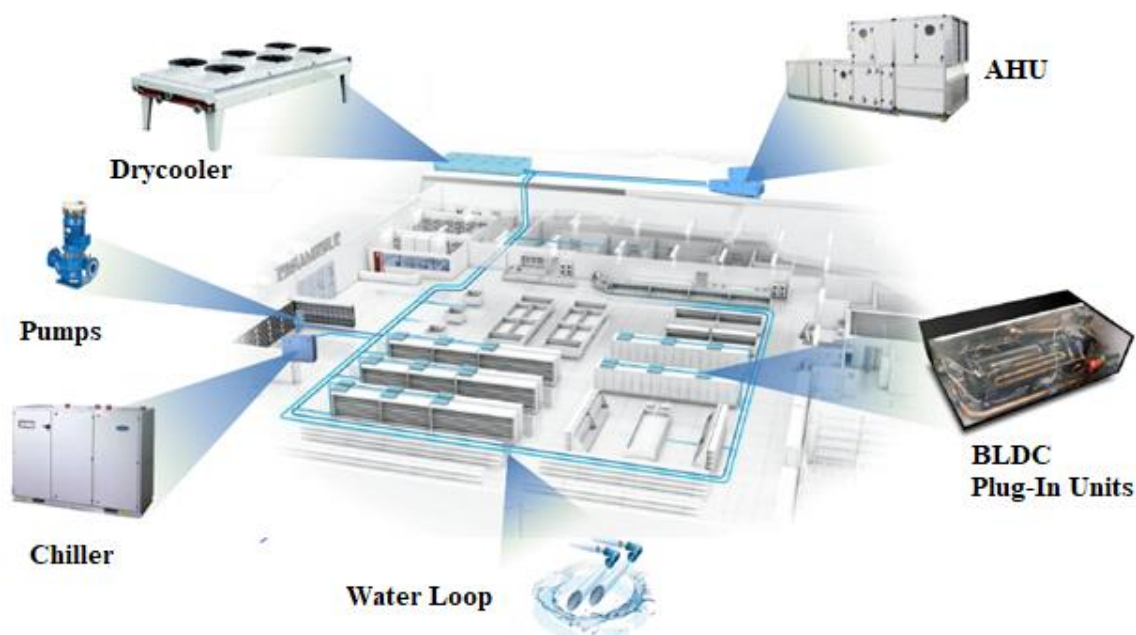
Schema dell'impianto di refrigerazione e condizionamento aria
